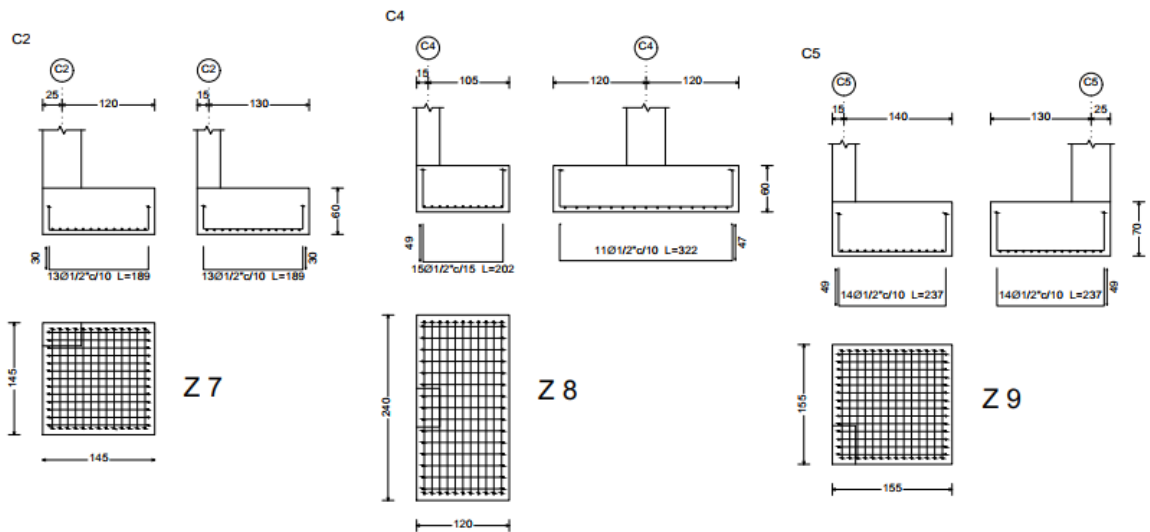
Despiece y armado de zapata-columna y sobrecimientos
